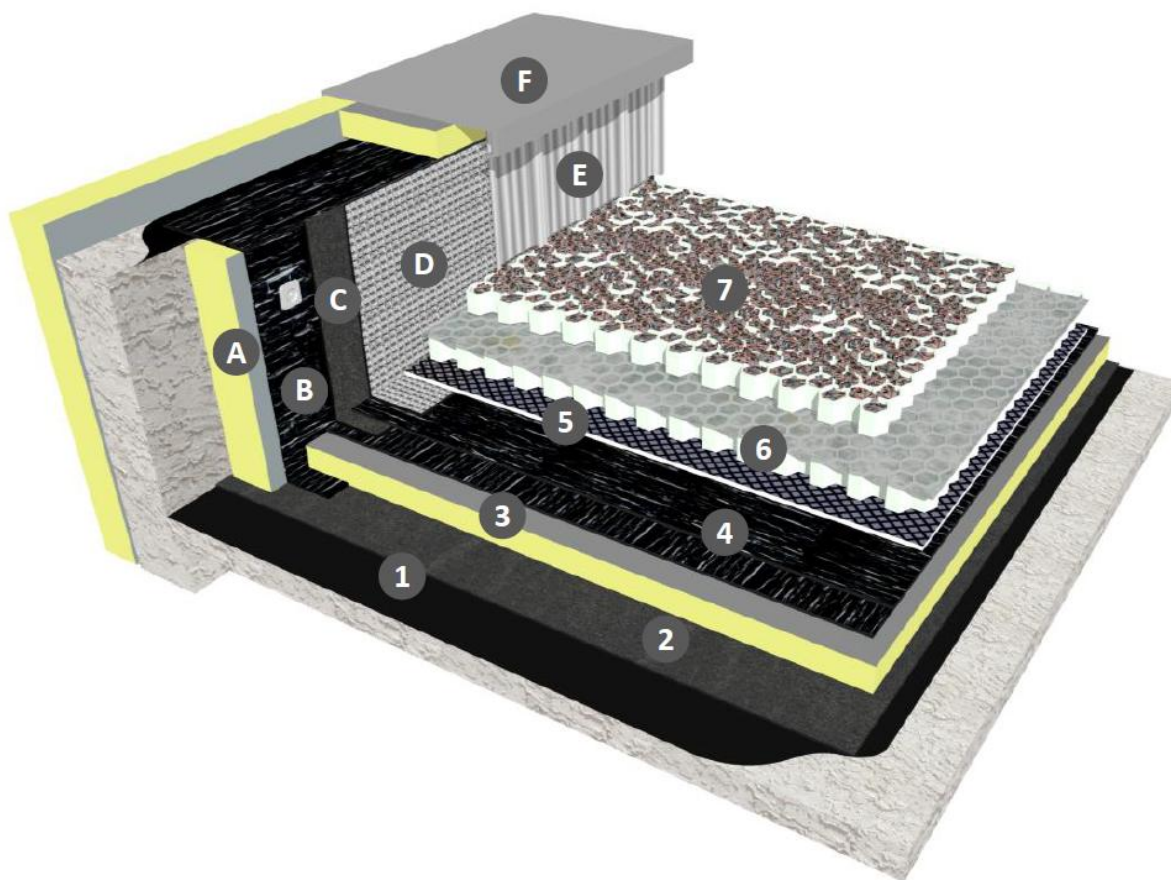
Toiture-terrace accessible aux véhicules légers avec protection par chaussée traditionnelle
